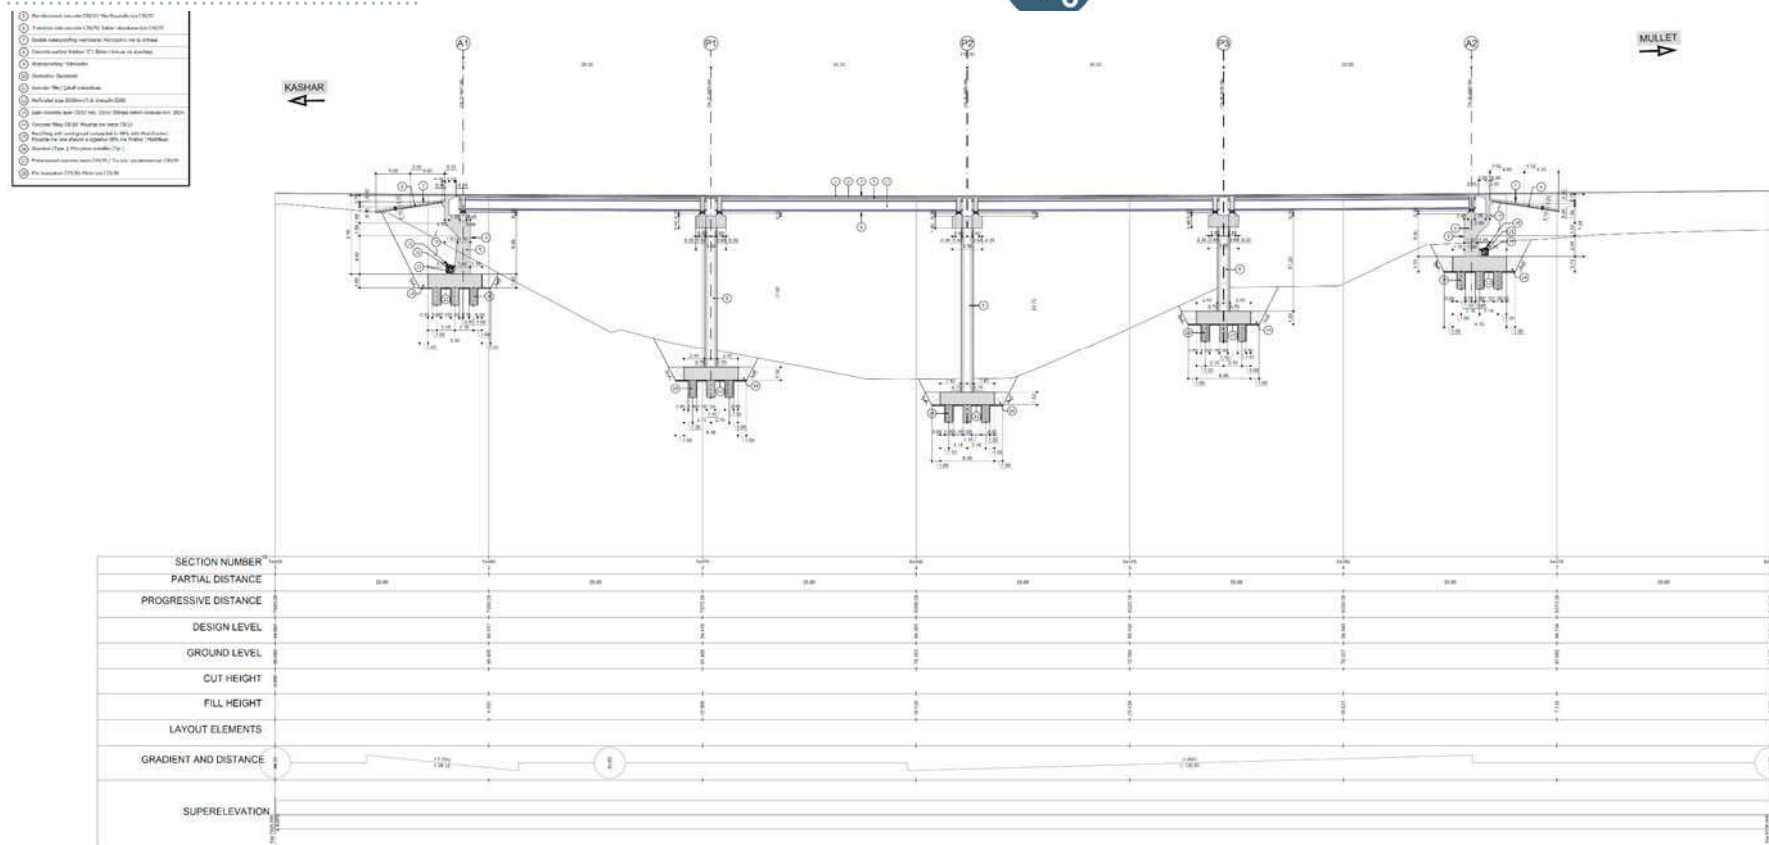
Pamje planimetrike e Urës 02, L=120m (Hapësira 4x30m)
